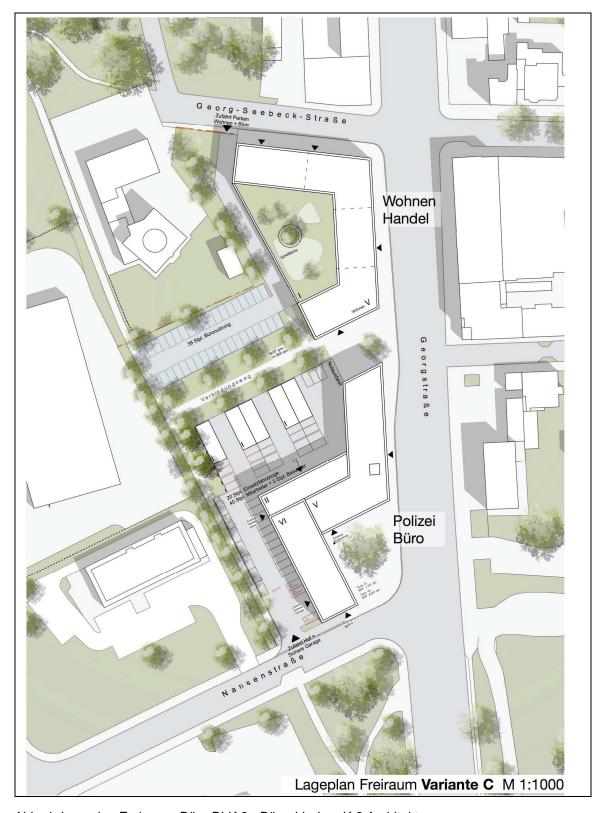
Lageplan Freiraum, Büro BLK 2 - Böge Lindner K 2 Architekten
